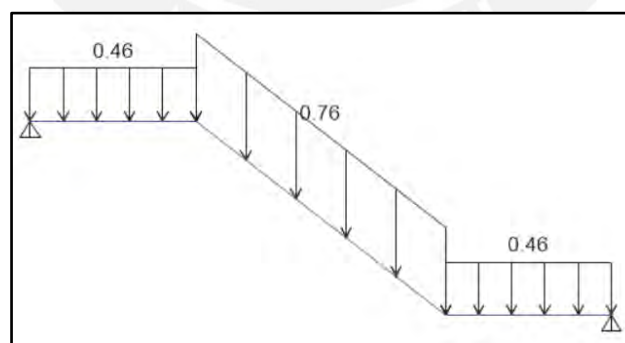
Cargas muertas PP + p.t aplicadas (ton/m)
